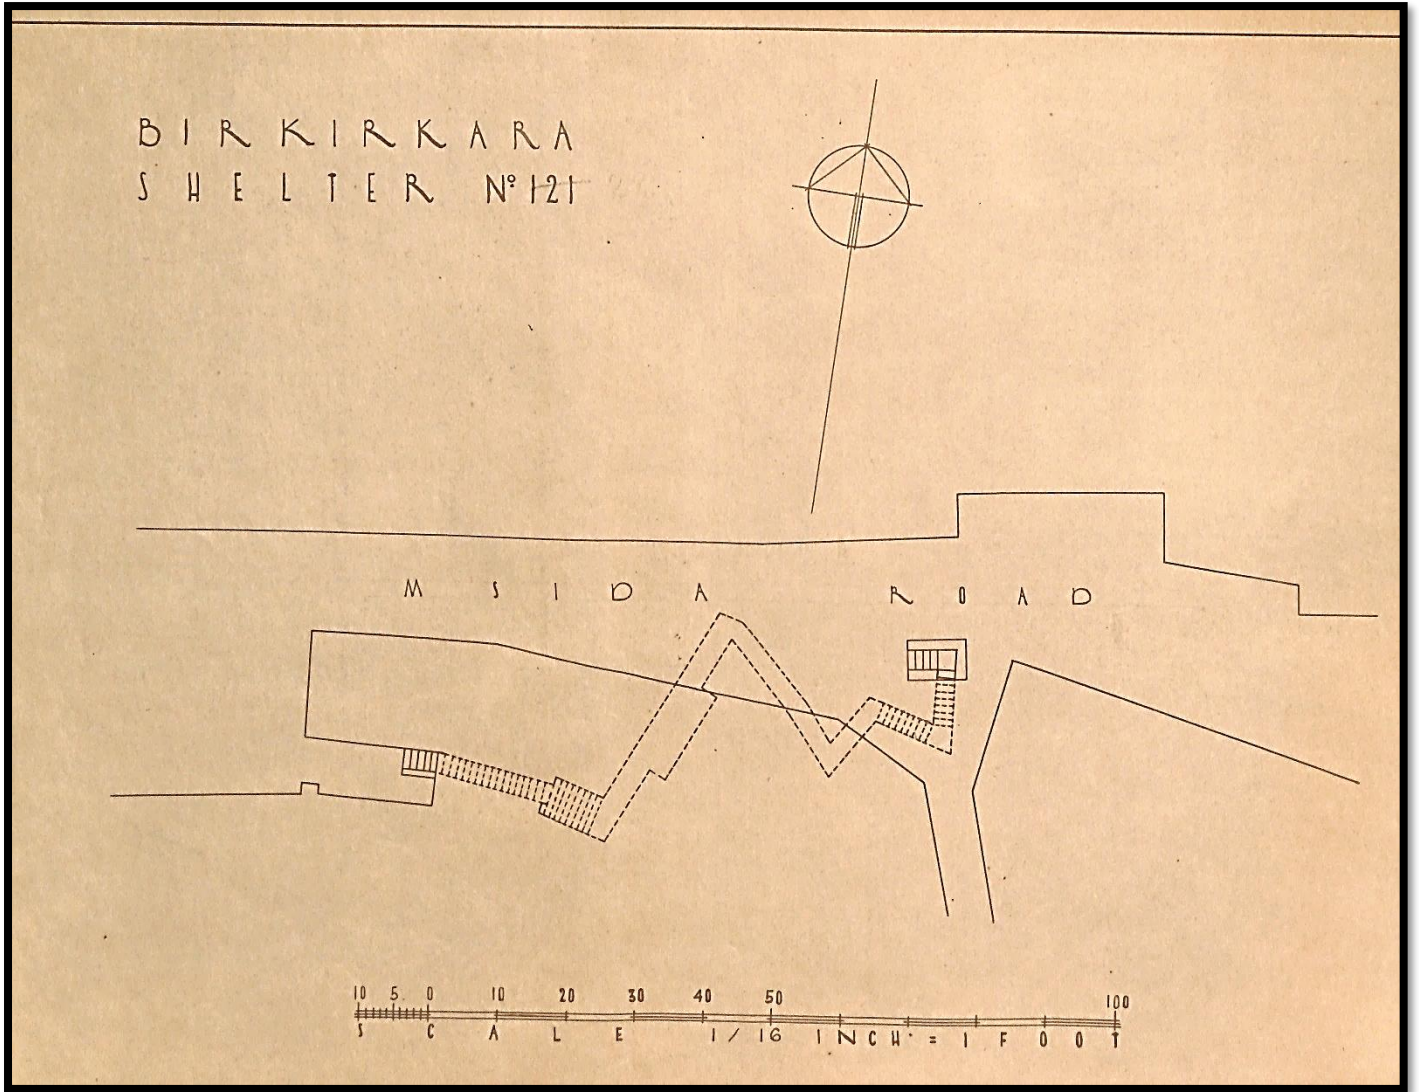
Planta do Abrigo nº121 (28) "Msida Road"
